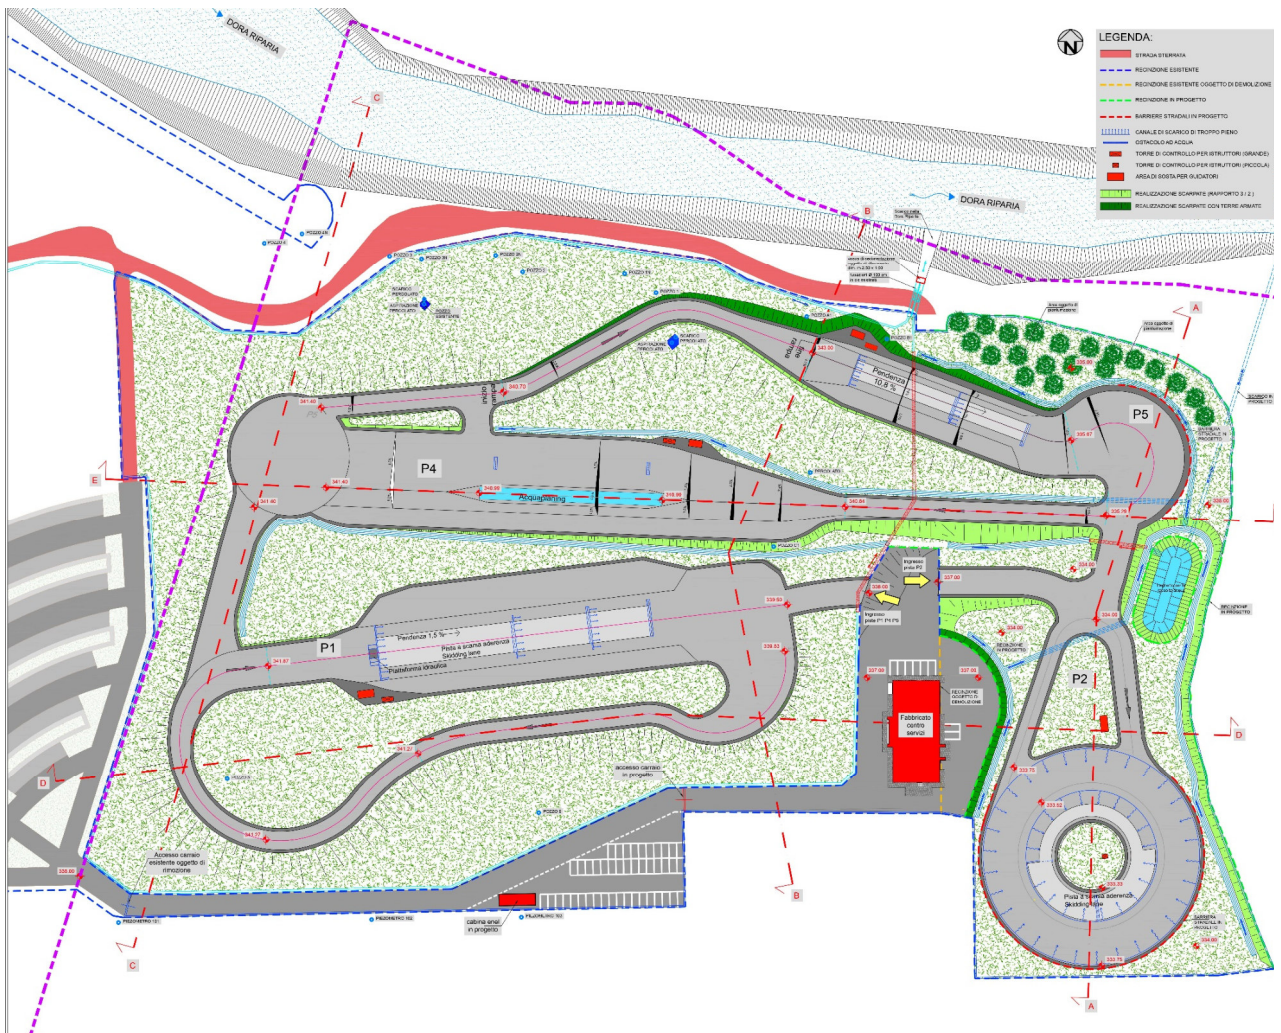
Buttiglieria Alta. Planimetria di progetto
